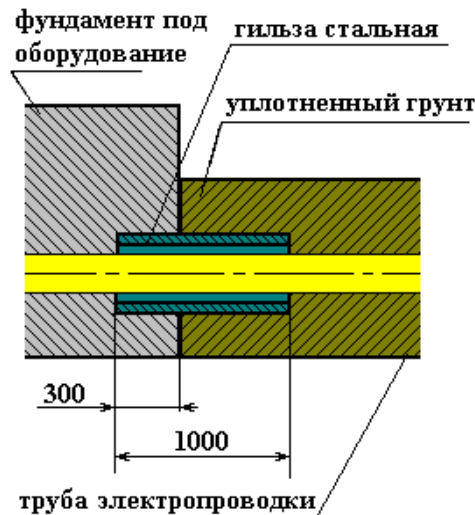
Защита трубы при выходе из фундамента в грунт.
